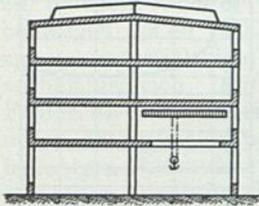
Mehrgeschoßbau mit Deckendurchbruch zum Zusammenbau hoher Maschinen oder zum Entladen von Eisenbahnwagen im Erdgeschoß.
